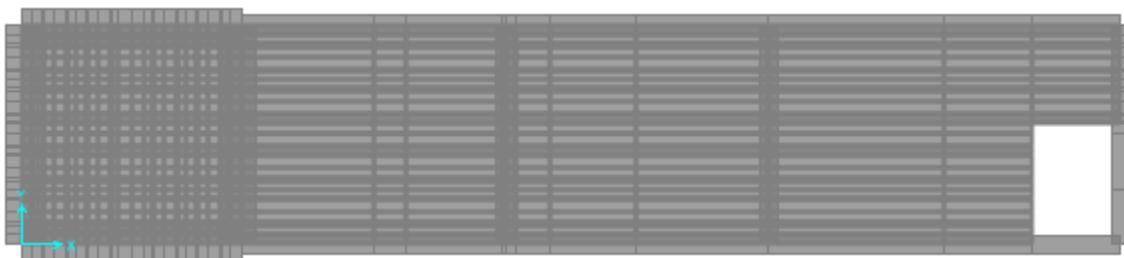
Vista en planta "Losa de Reacción" - SAP 2000
